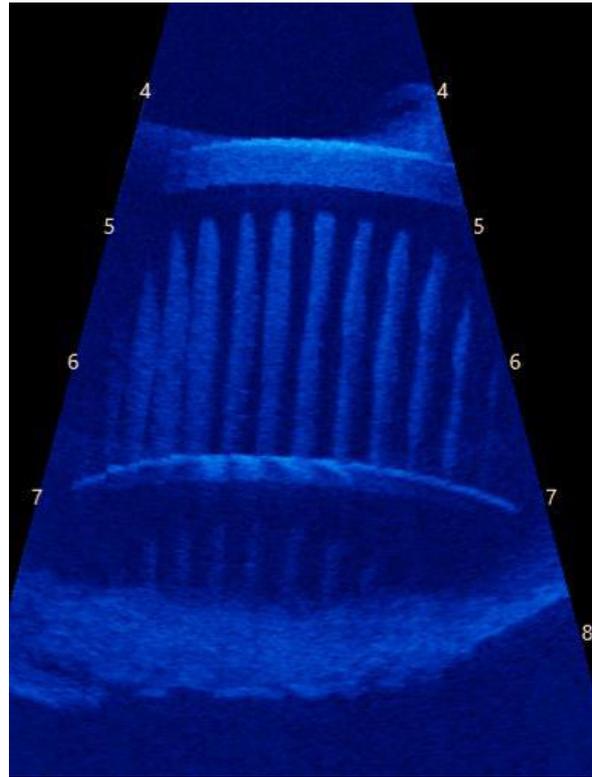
Vérification du dégagement par caméra acoustique des grilles de la prise d'eau d'un conduit de vidange de fond
